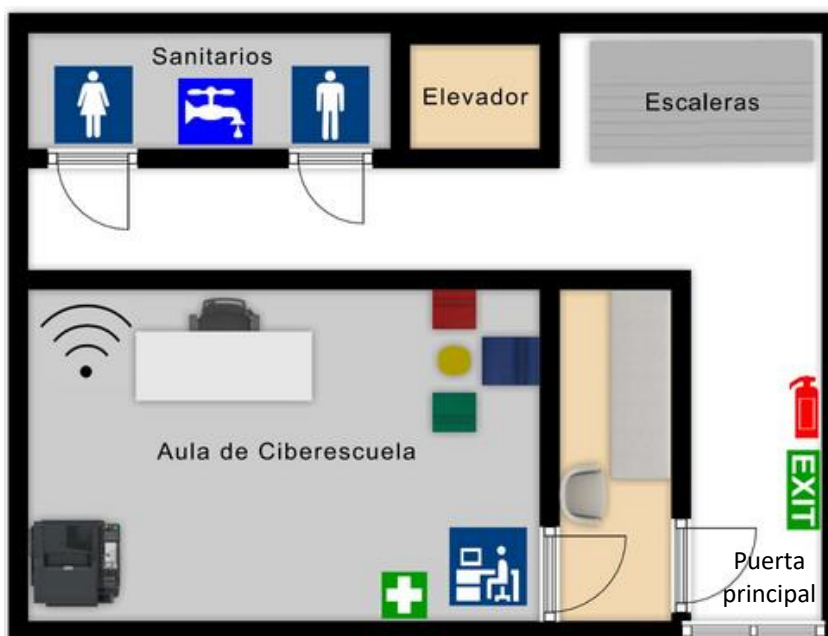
Croquis de PILARES San Andrés Ahuayucan- planta baja
